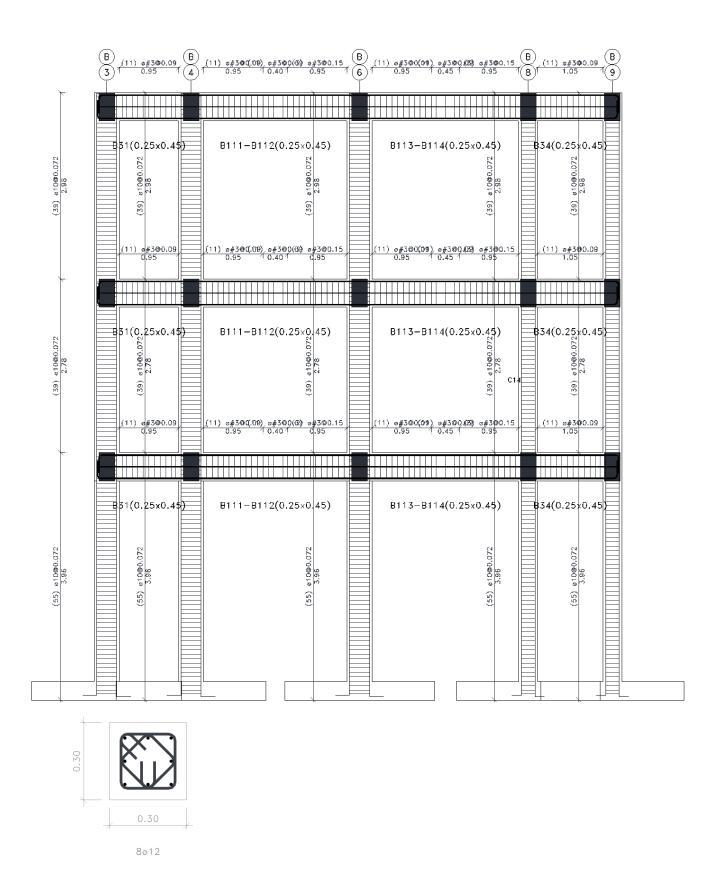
Detalle estructural de la columna para la vivienda residencial multifamiliar 12D.
